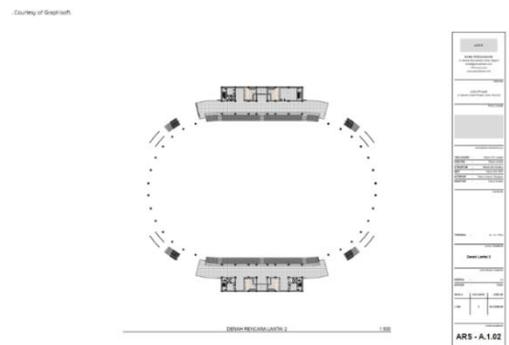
Zoning Plan (sumber : penulis, 2023)
